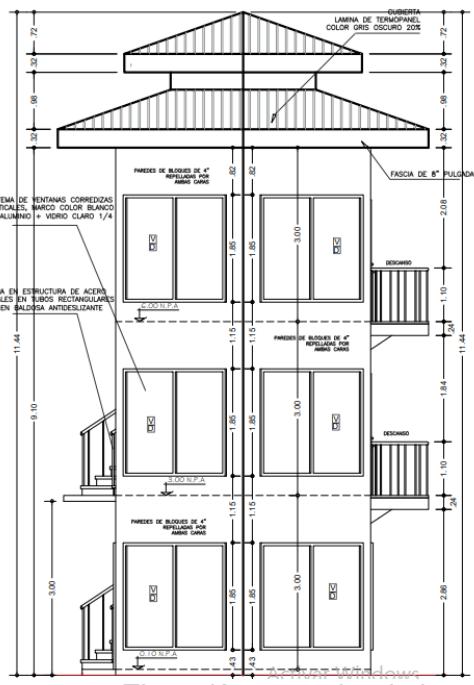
Vista e la planta arquitectónica de los apartamentos. Fuente: Plano de anteproyecto
